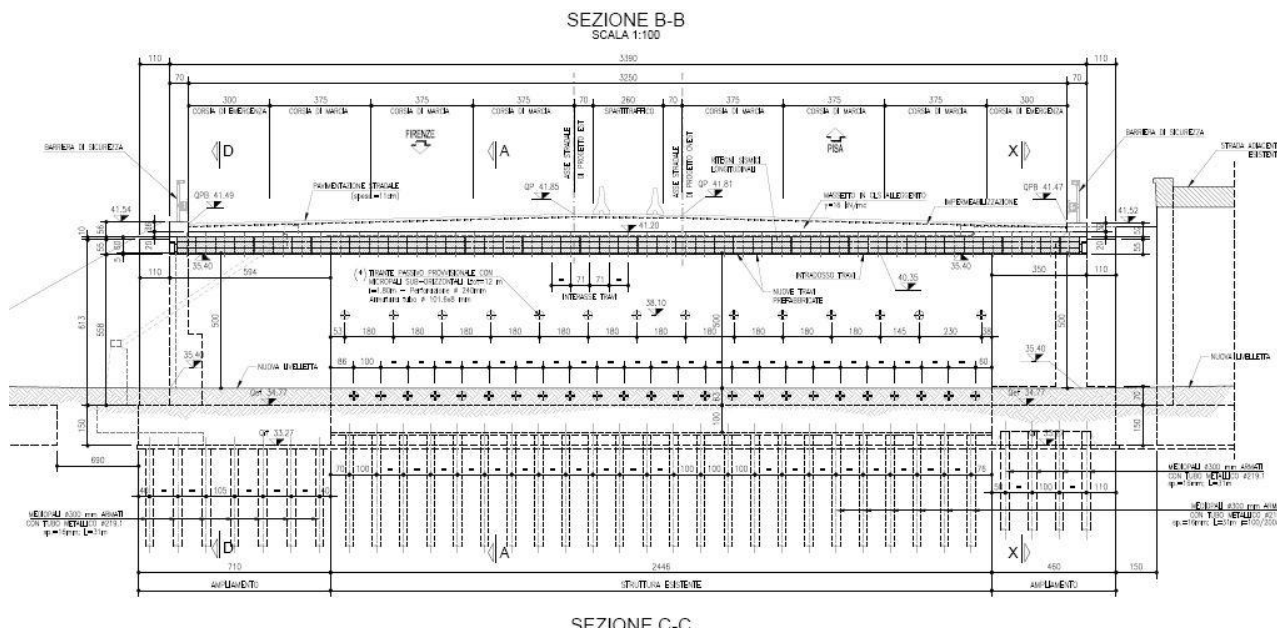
Sezioni tipo progetto ampliamento sottovia.
